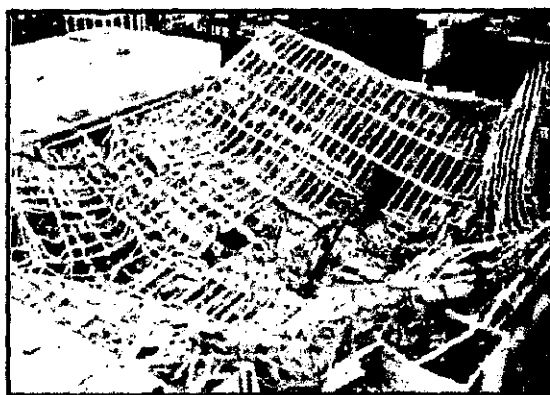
Colapso de Coliseo, Connecticut, 1978.
